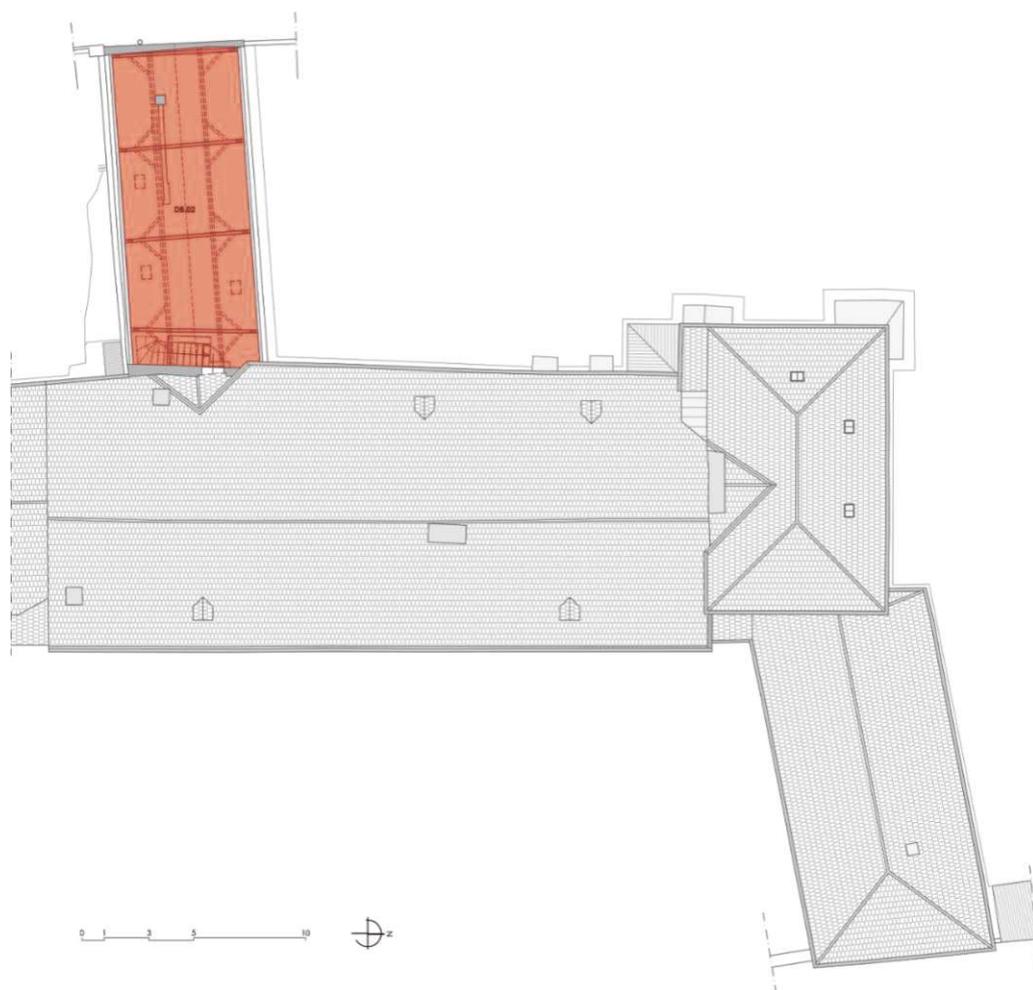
Obergeschoss Übersichtsplan- DB.02
